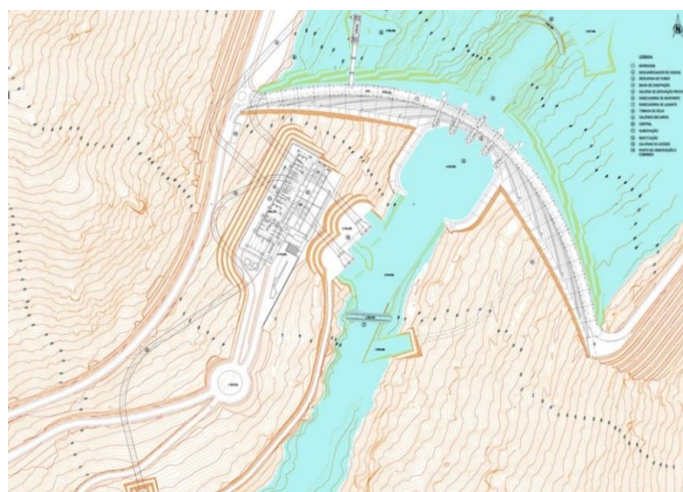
Desenho em planta da barragem escalão montante (fonte: EDP)
